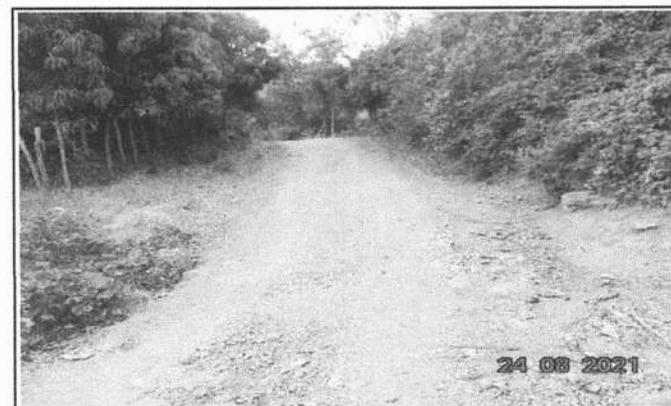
LOCAL DA CONSTRUÇÃO-BUEIRO
